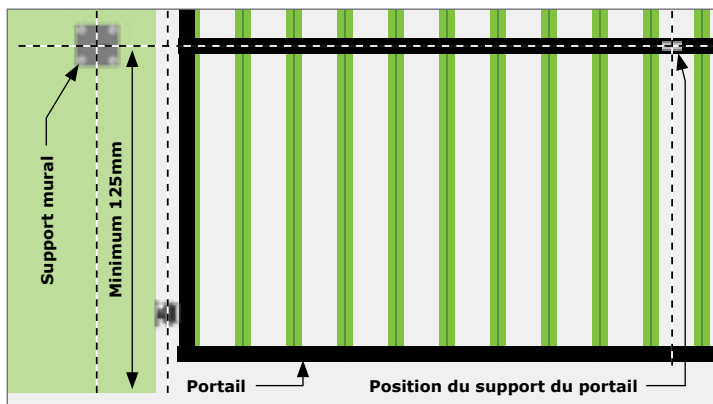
HAUTEUR DU SUPPORT MURAL
